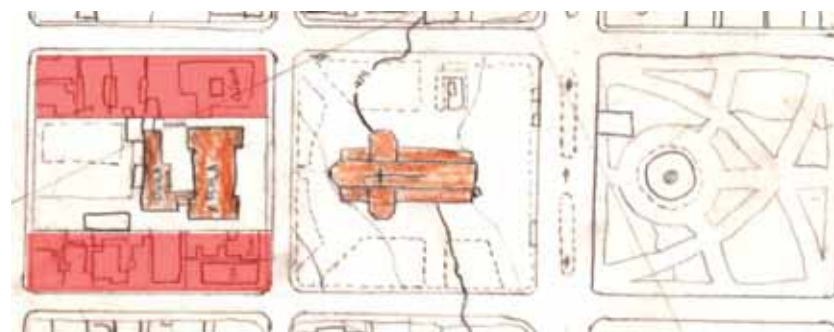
Em vermelho os lotes com poucos pavimentos que seriam desapropriados para a proposta de terminal. Desenho do autor retirado de planta de lotes de 1973.
